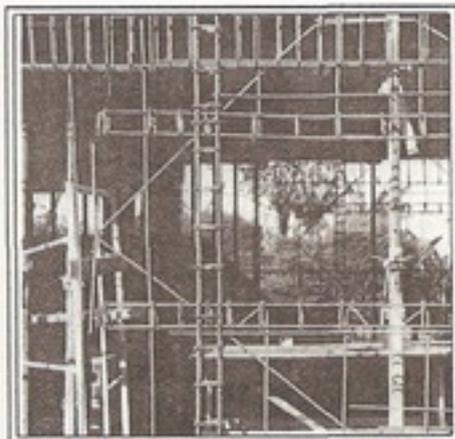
Detalle constructivo del refuerzo en zonas adyacentes a vanos para puertas y ventanas.
